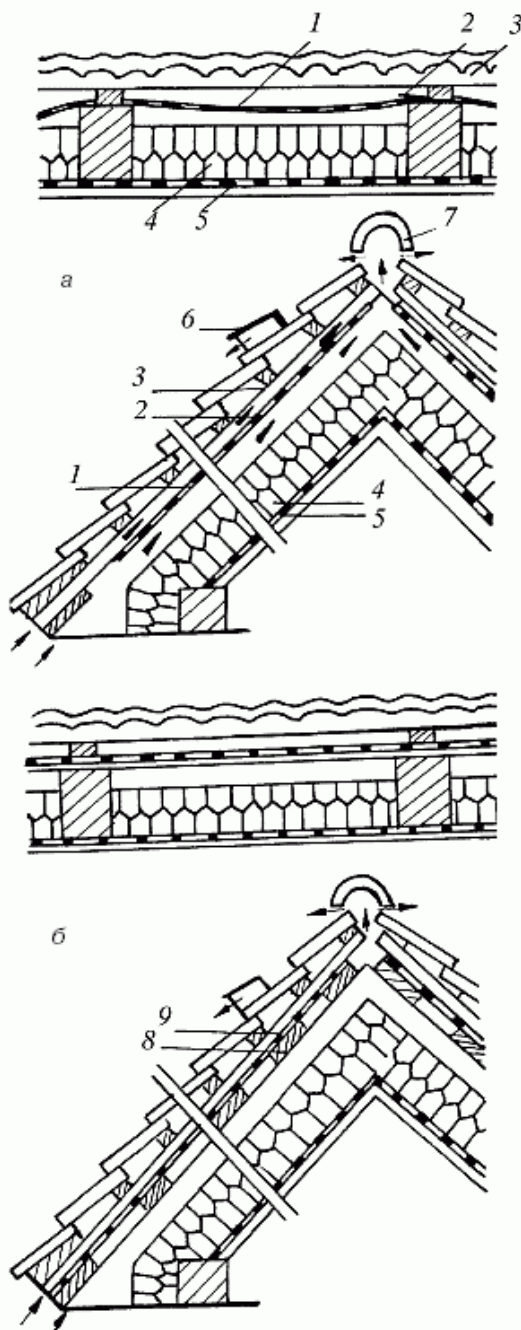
Изоляция между стропилами: а – с прокладной лентой; б – с деревянной обшивкой и защитным слоем; 1 – прокладная лента; 2 – контрбрусья; 3 – обрешетка; 4 – теплоизоляция; 5 – гидроизоляция; 6 – черепица; 7 – вентиляционный конек; 8 – деревянная обшивка; 9 – защитный слой
